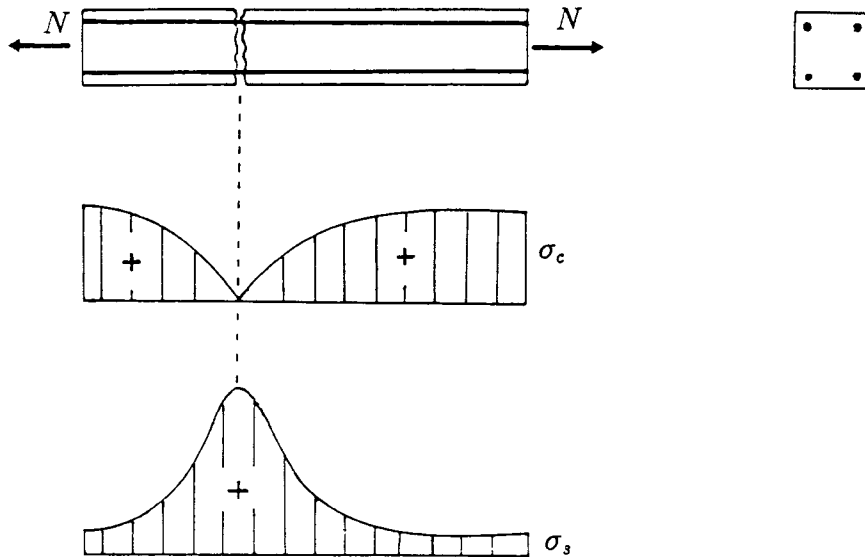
Tracções no betão e no aço de um tirante de betão armado fendilhado.
